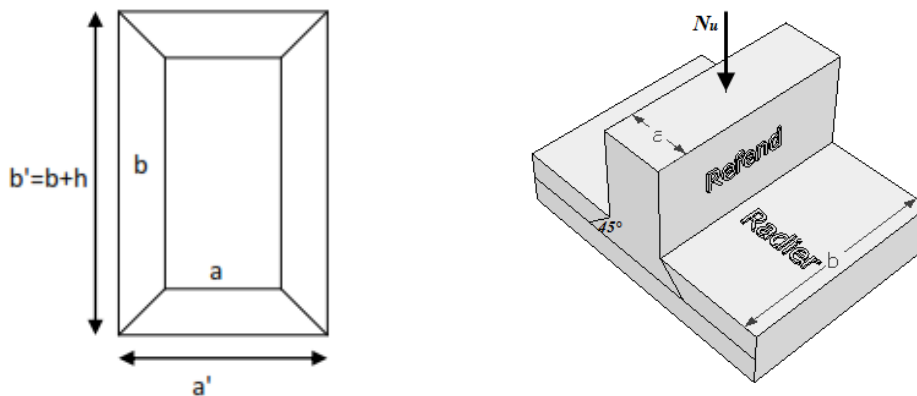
Périmètre utile des voiles et des poteaux.
